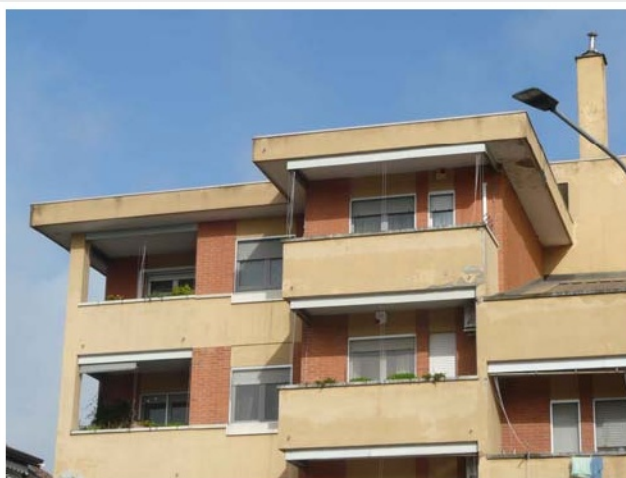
Alloggio al piano terzo facciata ovest e copertura soffitta
